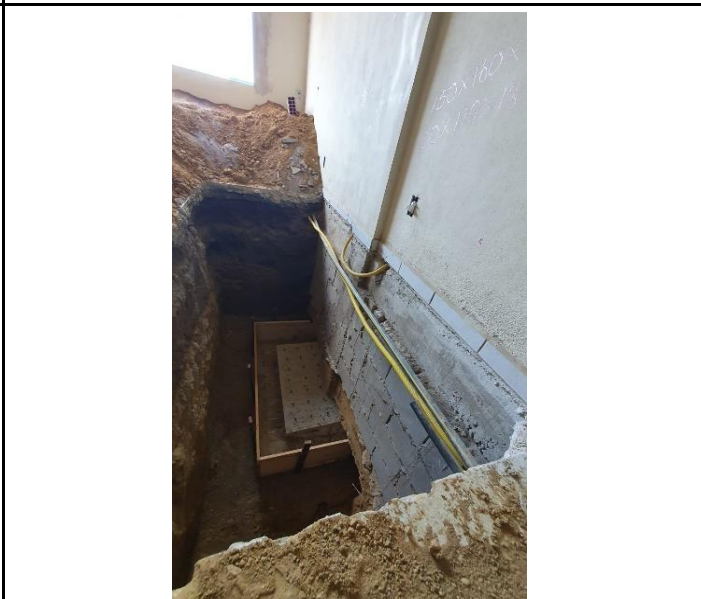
Montagem de aço e forma para reforço estrutural em sapata.
